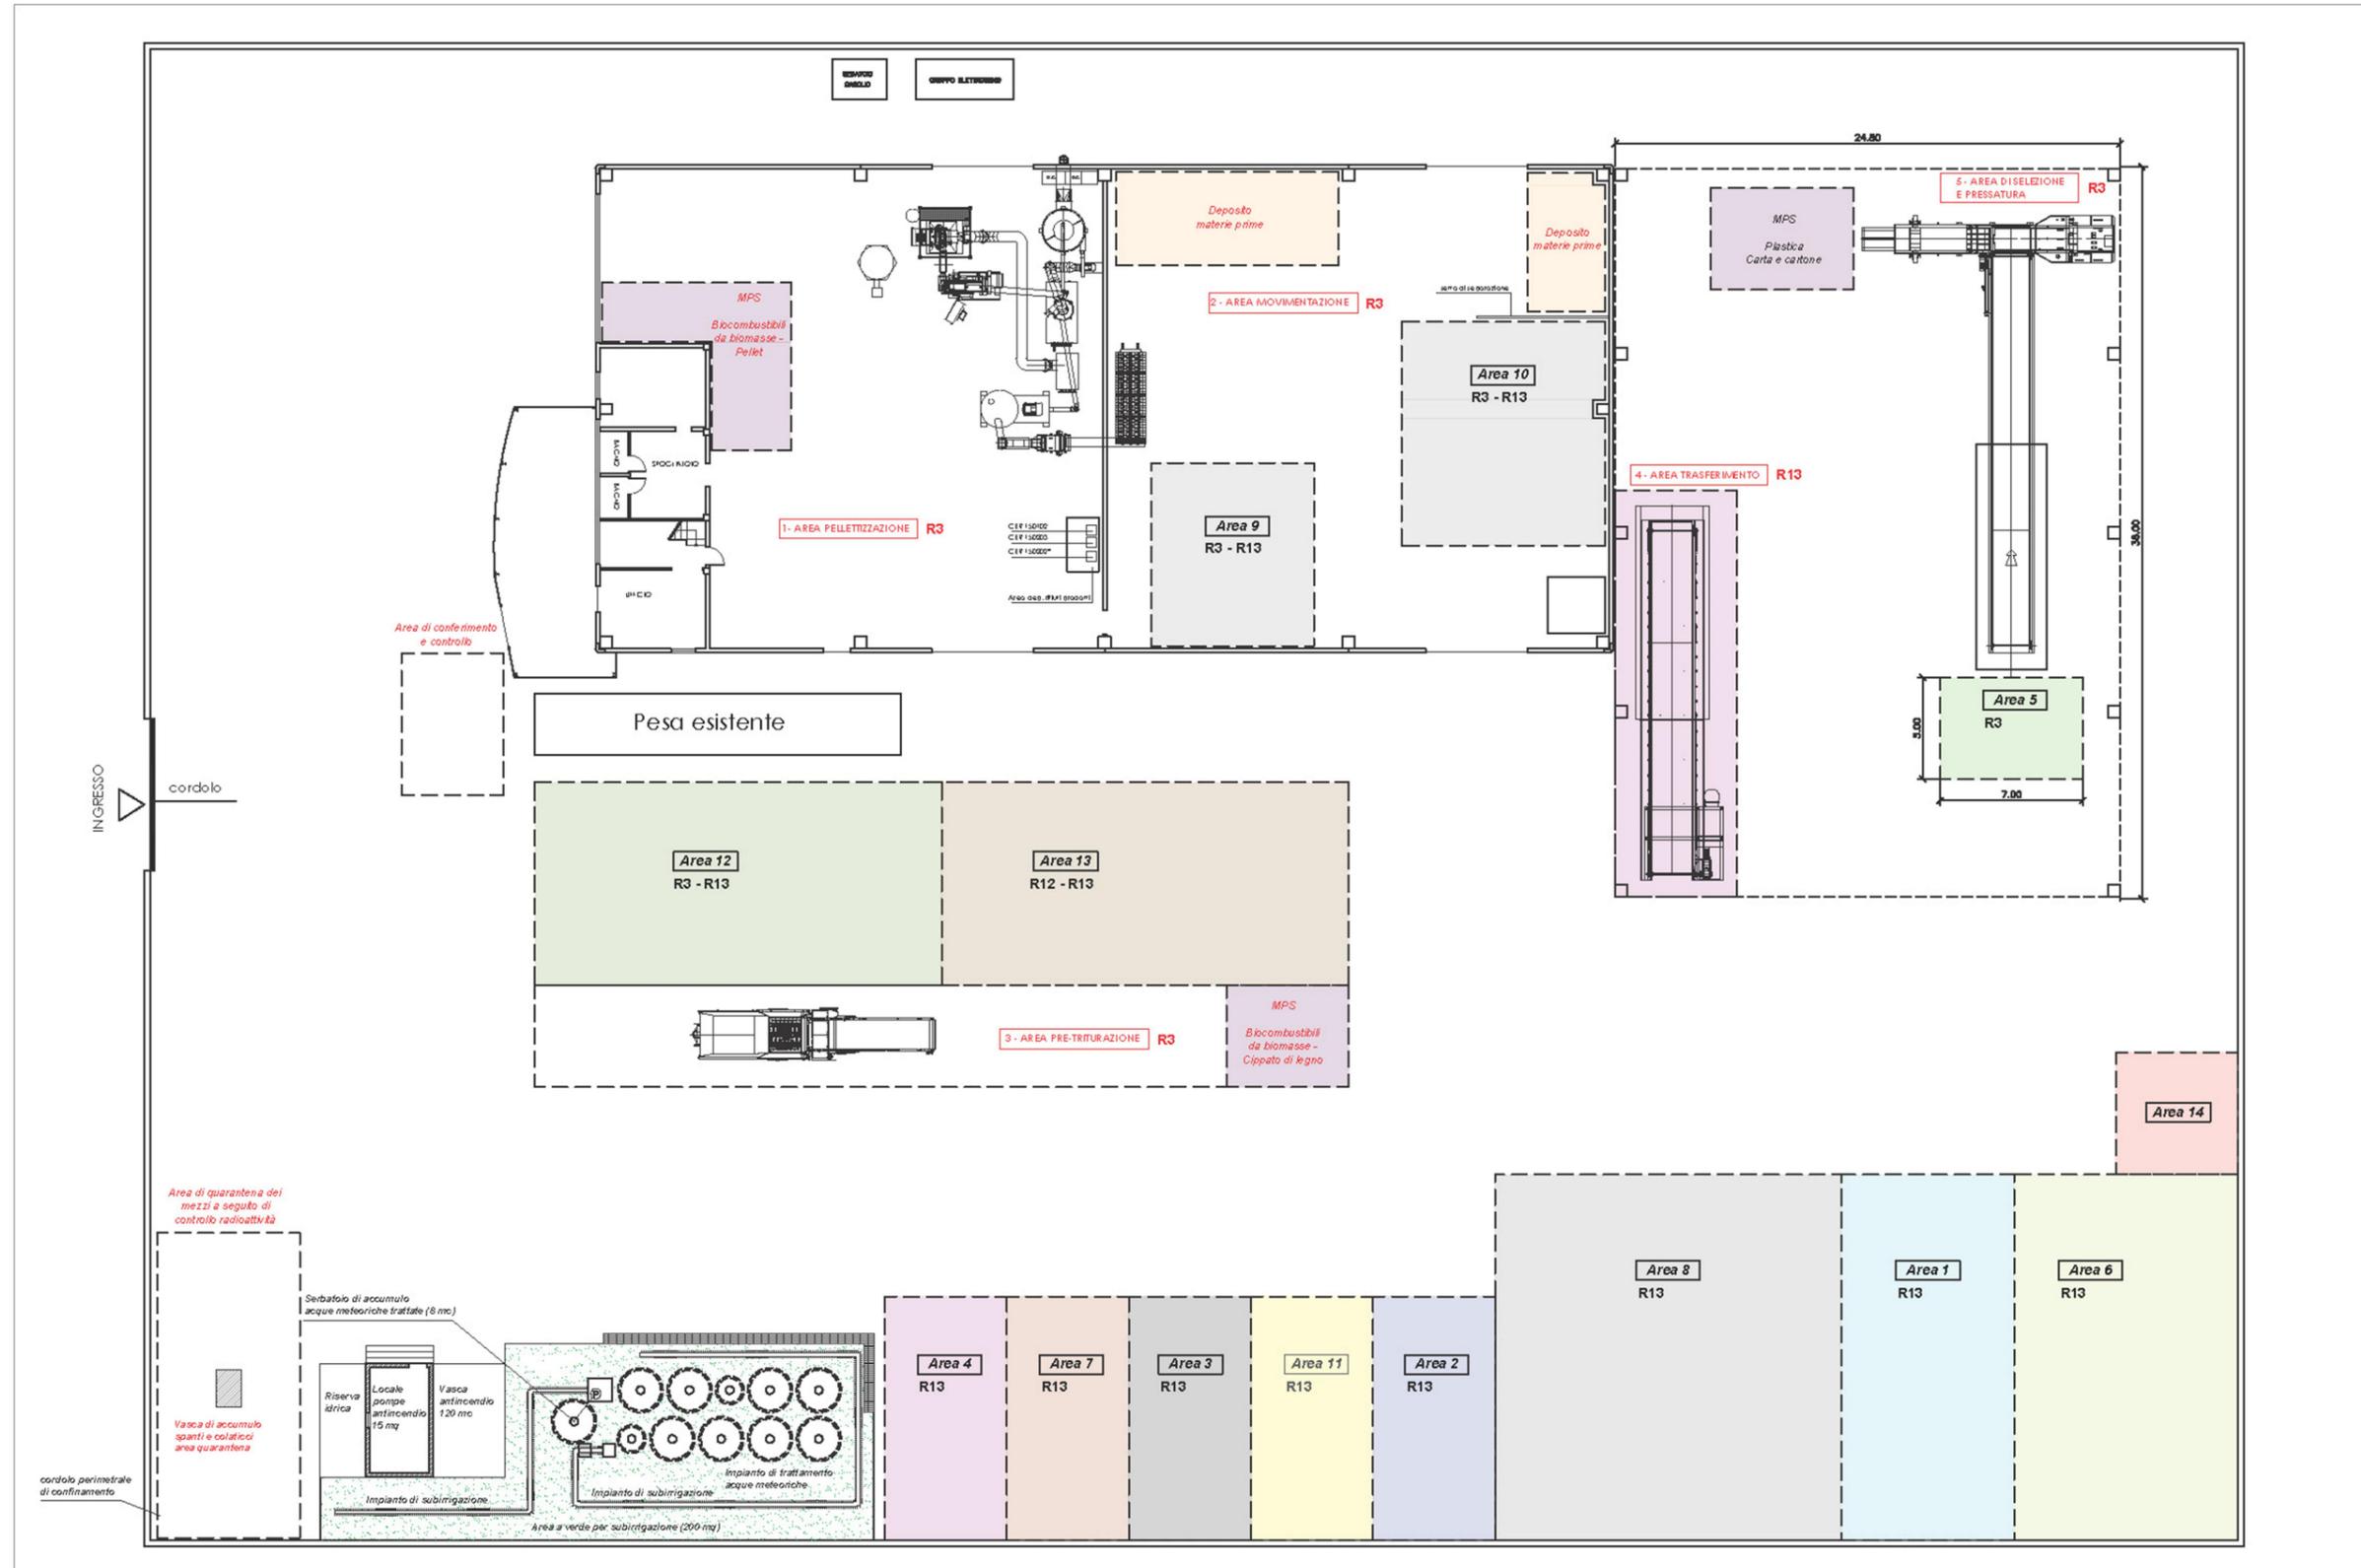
Planimetria con indicazione aree messa in riserva e recupero
